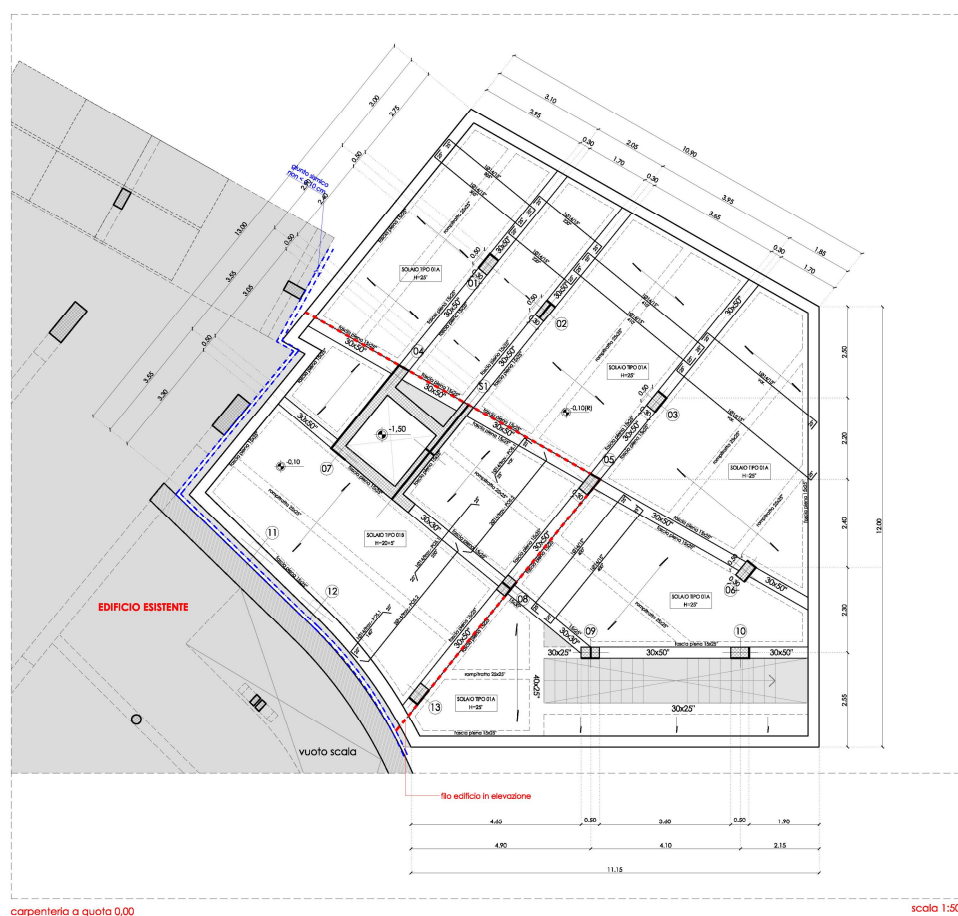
Blocco 1 - Nuovo blocco servizi - carpenteria alla quota +0,00
